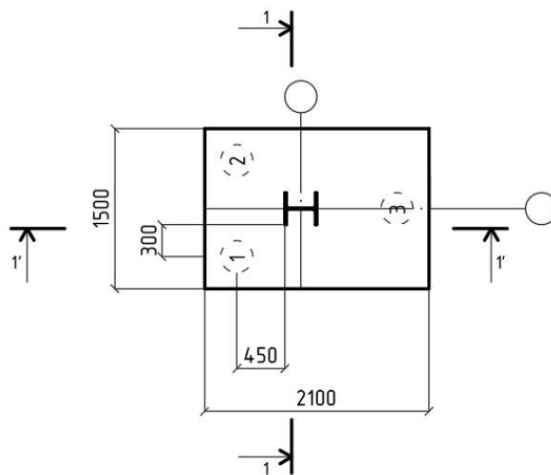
Схема к расчету ростверка на изгиб
